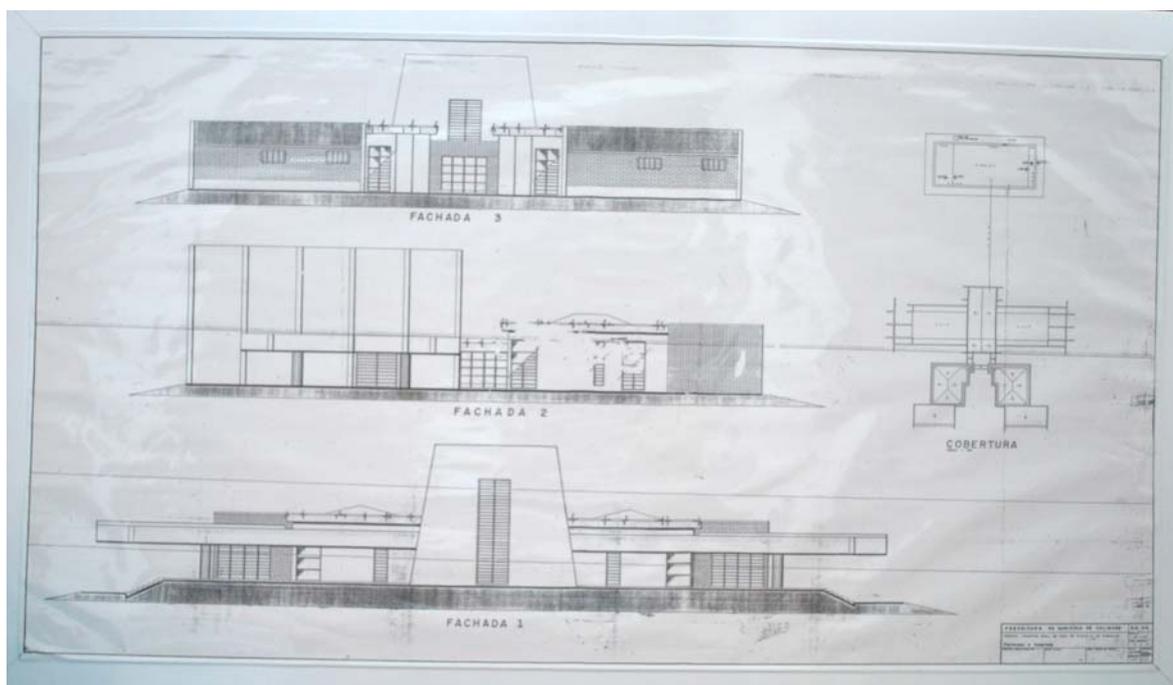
Fotografia: fachada da planta da sede modernista. Fonte: Prefeitura de Valinhos, 1993. Foto do pesquisador.
